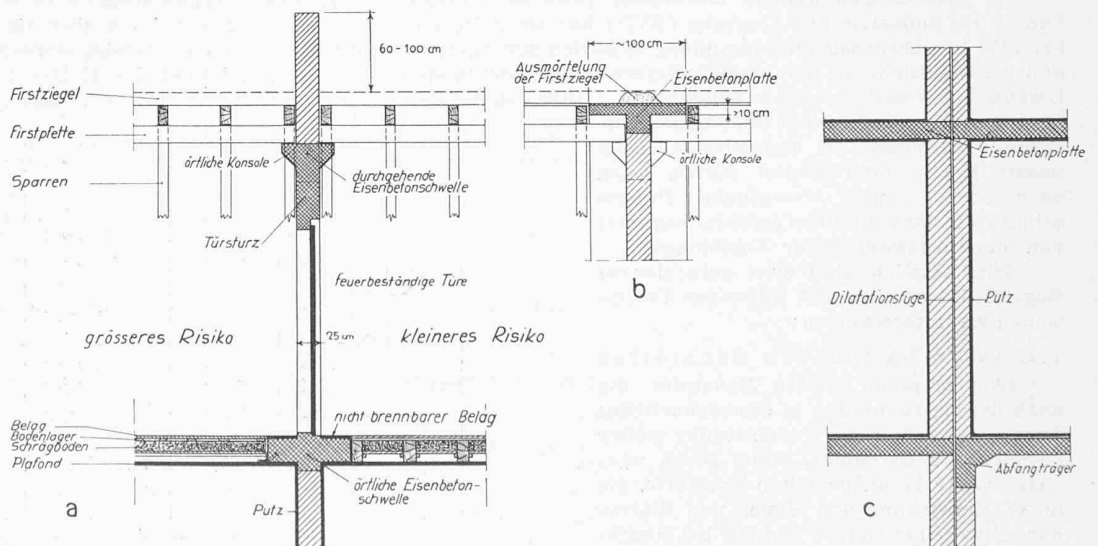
Schemata sachgemäss ausgeführter Brandmauern: a hochgezogene, b abgedeckte, c mit Dilationsfuge versehene Brandmauer, Masstab 1 : 75
